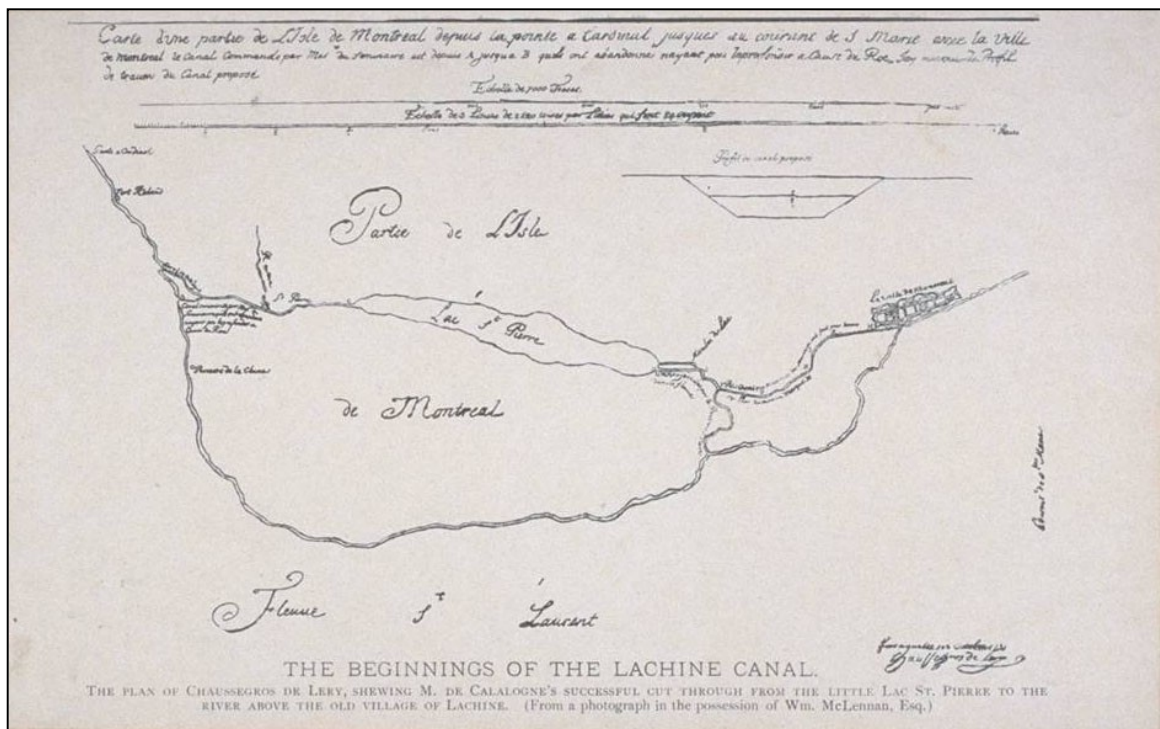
Plan pour l'amélioration du projet de canal par Chaussegros de Léry.
